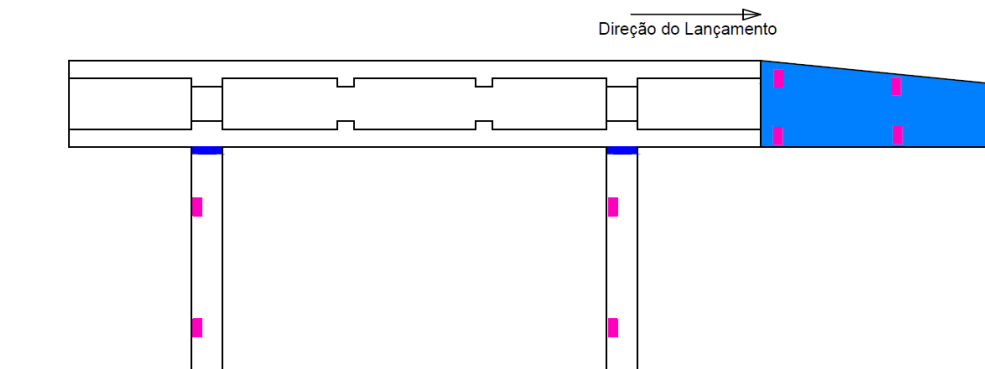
Localização dos inclinómetros para medição das rotações dos pilares e nariz.
